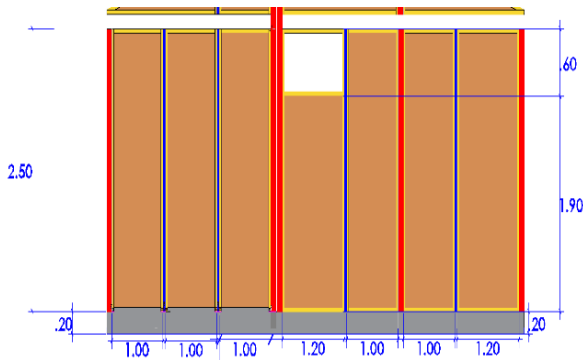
Dimensiones de los paneles y columna de la vivienda modular (Fuente: Propia)
